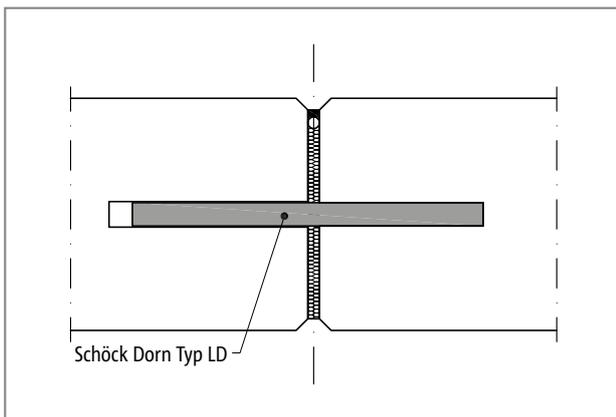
Schöck Dorn: Dehnfugenausbildung Ortbeton
